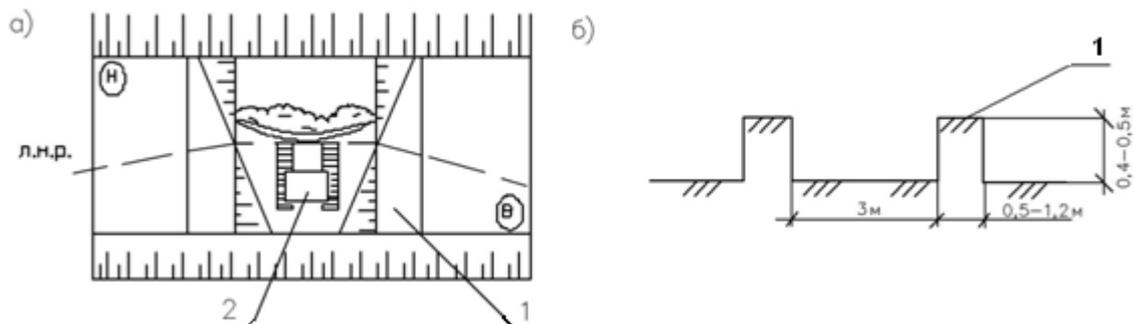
Траншейный способ разработки грунтов бульдозером:
